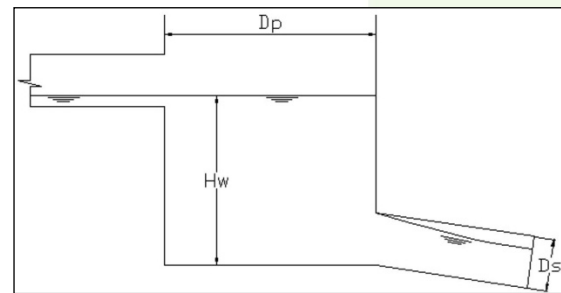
Unión de tuberías con caída en la estructura de conexión y/o inspección
